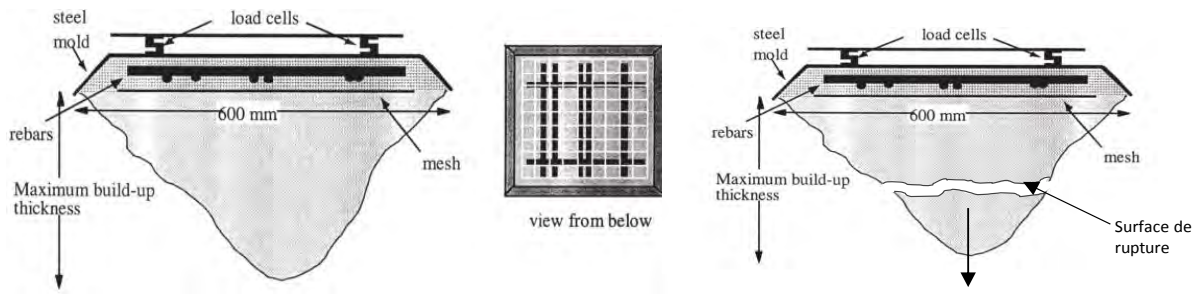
Montage pour évaluation de l'épaisseur maximale de passe. projection en plafond sur un support avec armatures (Jolin et al. 1999)
